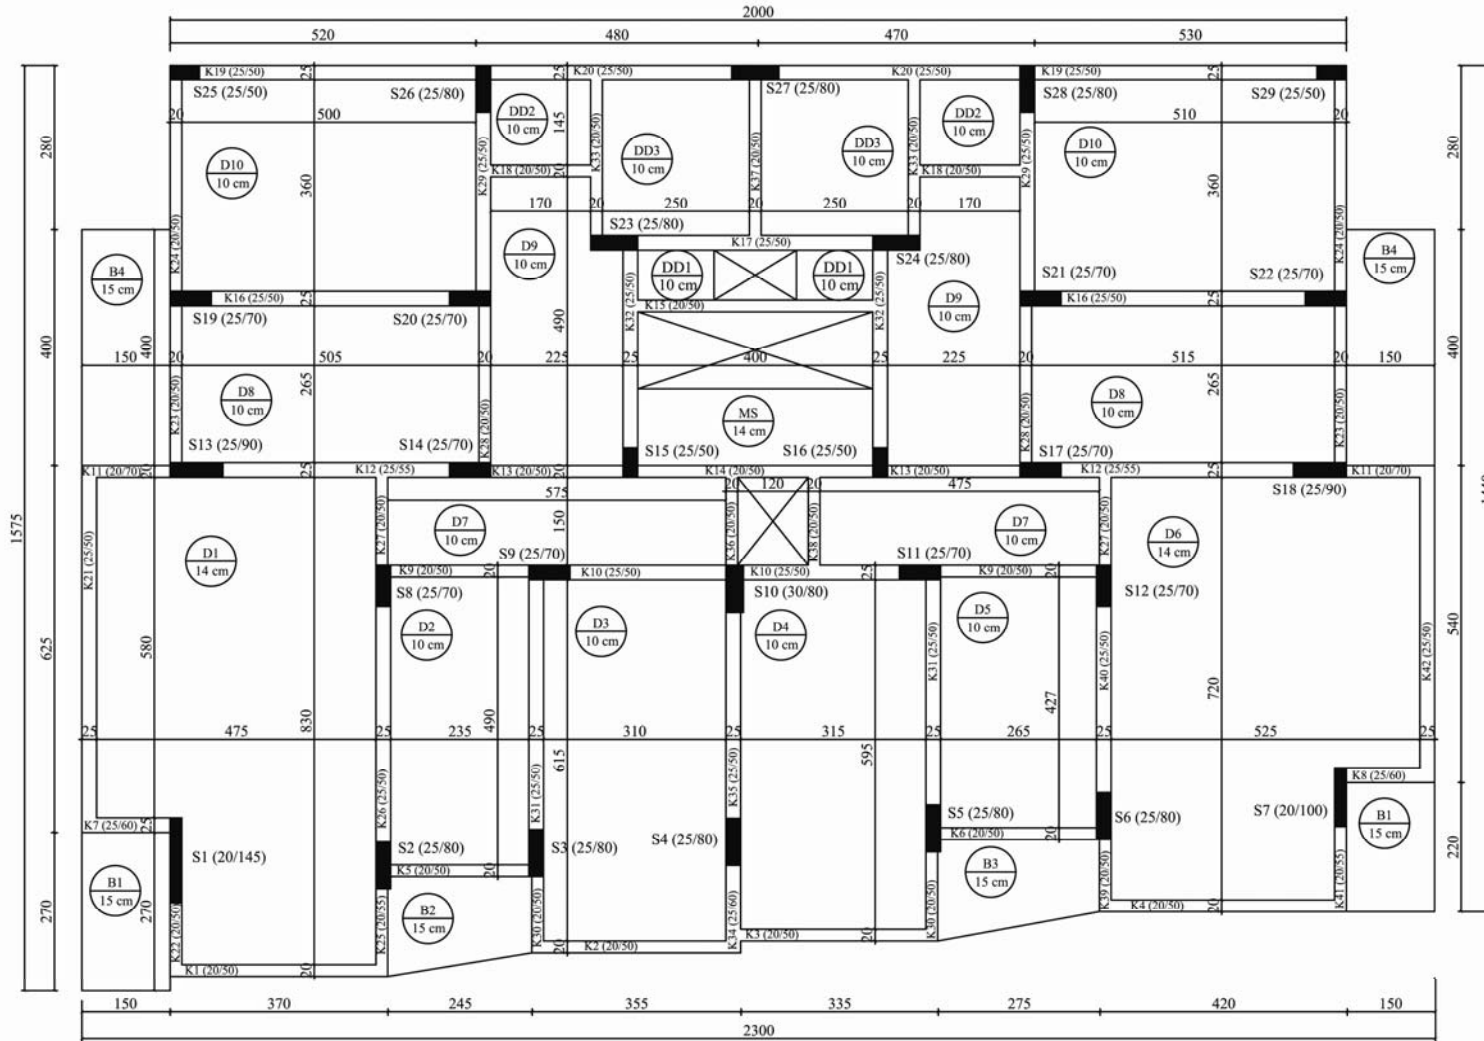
B6\_1'in kat kalıp planı
